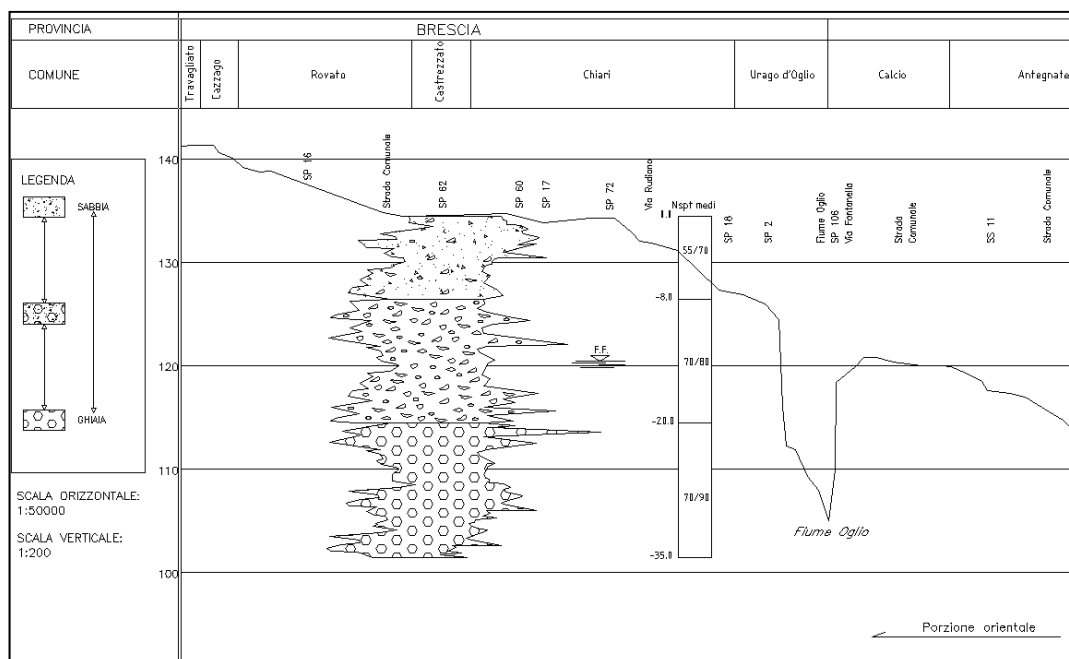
Estratto Sezione stratigrafica (da progetto BreBeMi, 2003)
